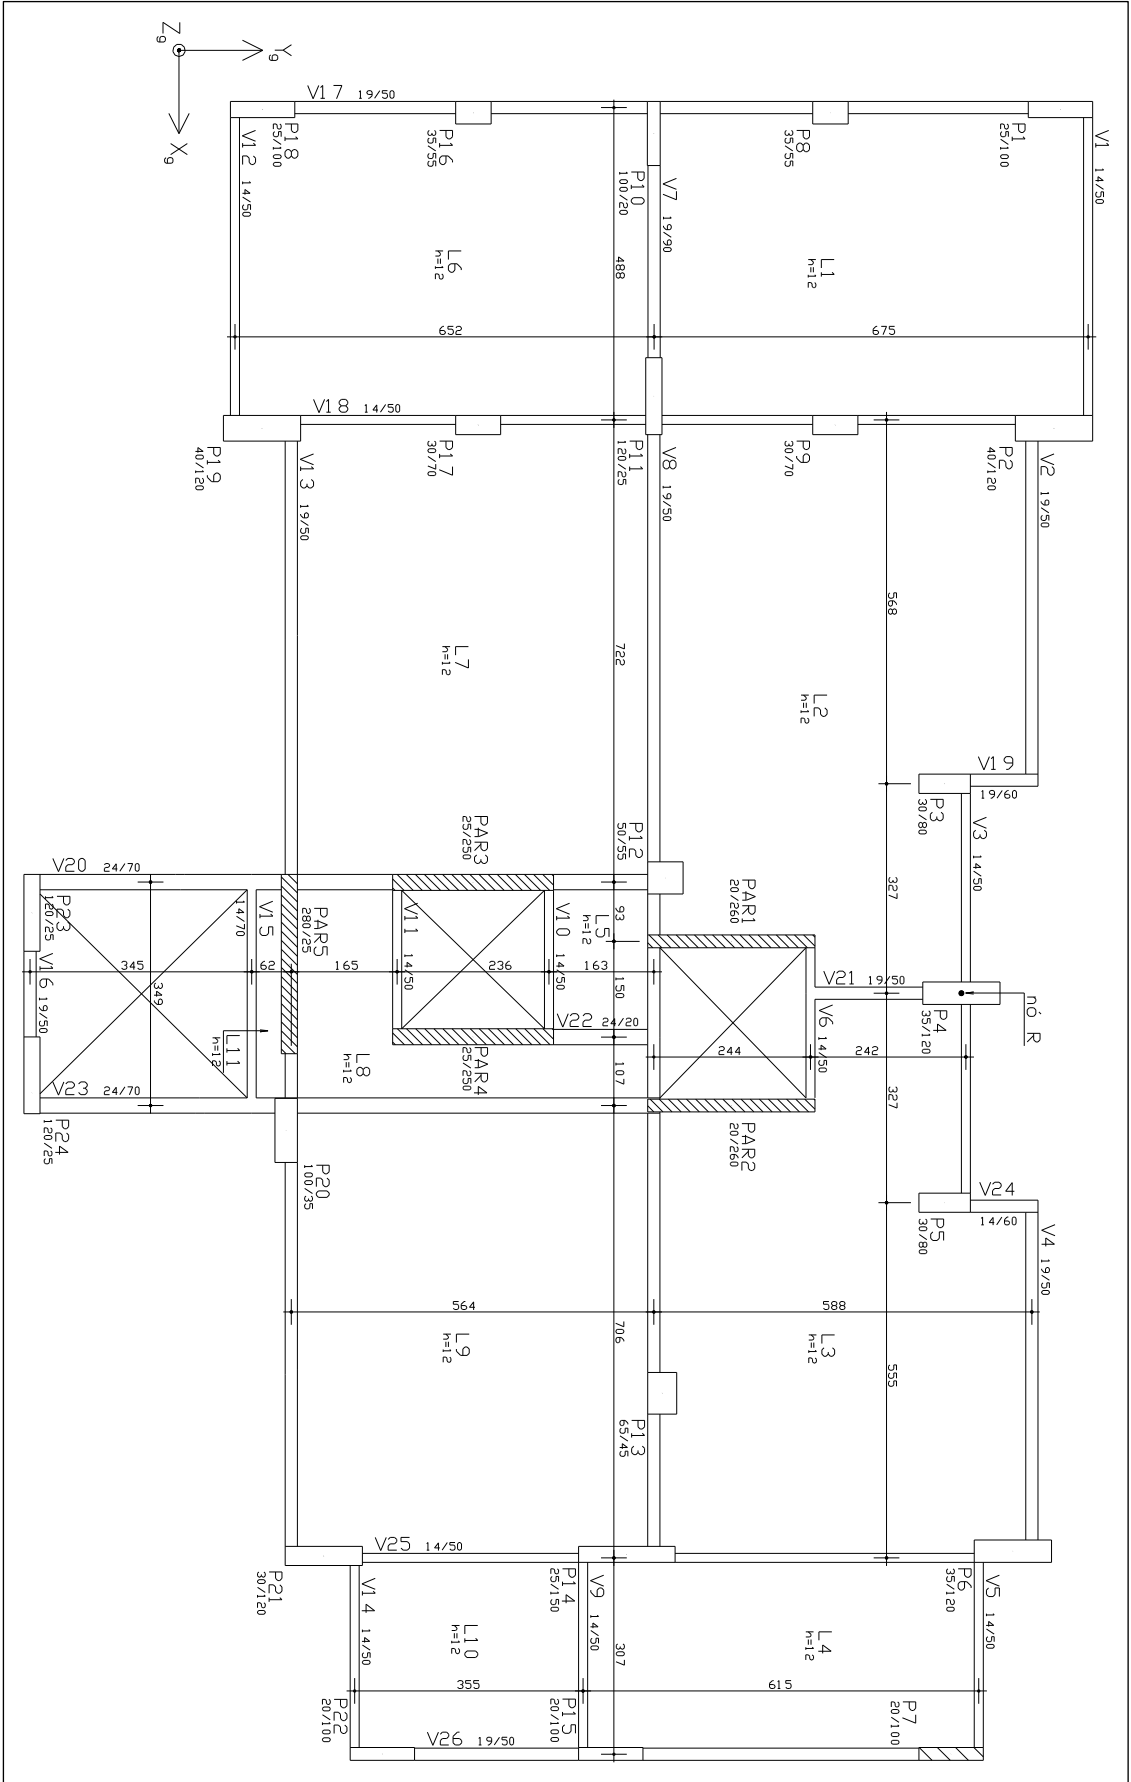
planta baixa do pavimento tipo – exemplo 4
